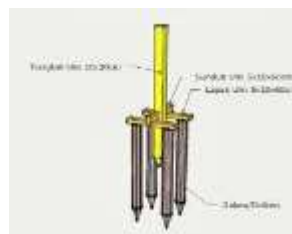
Potongan dan Detail Model Bangunan Tipe Rumah-B
